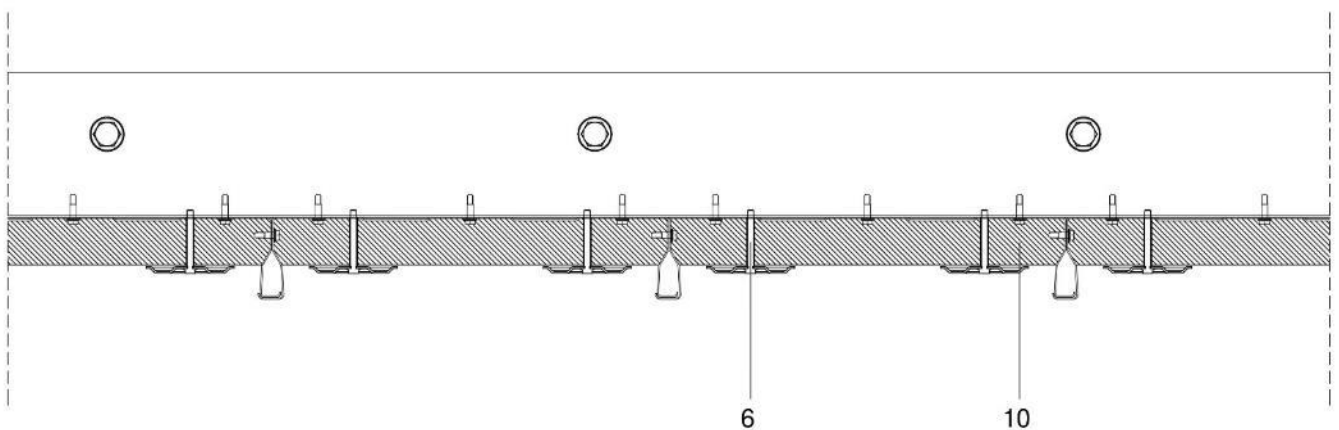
b: Sección horizontal con aislamiento térmico y fijación del aislamiento tipo 1.
